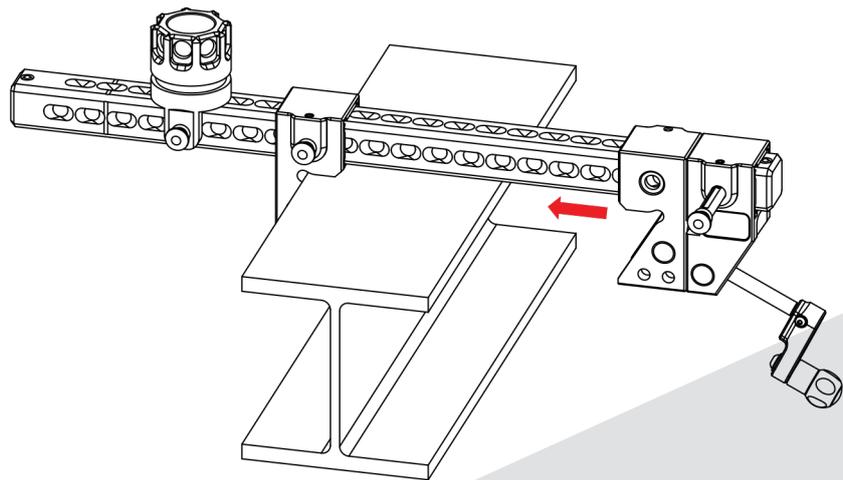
instalación de Abrazadera Viga I Paso 1
